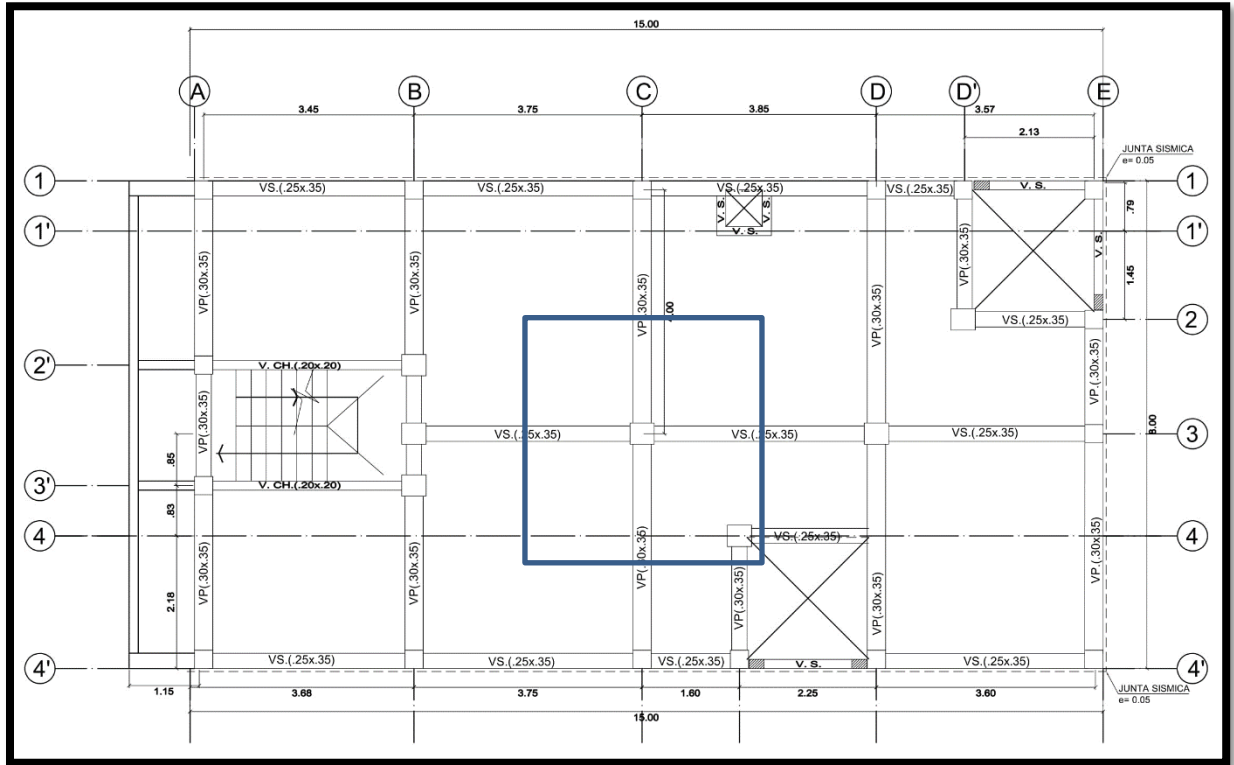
Plano de Planta - Estructuras de Edificio de 8 pisos
